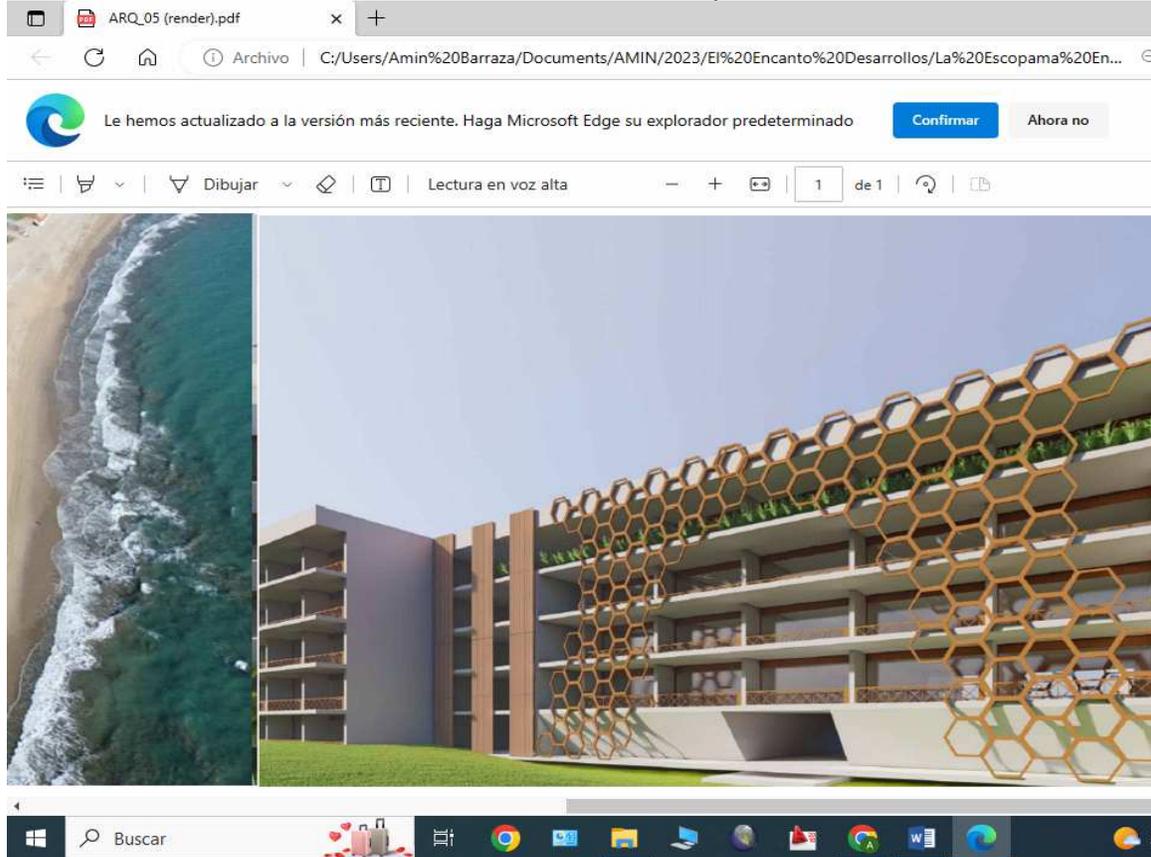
Render del interior del proyecto con vista a la fachada del edificio.
